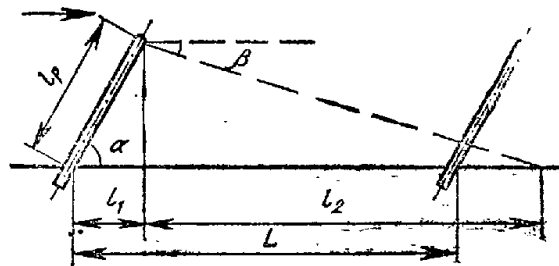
Расчетная схема к определению расстояния между шпорами
